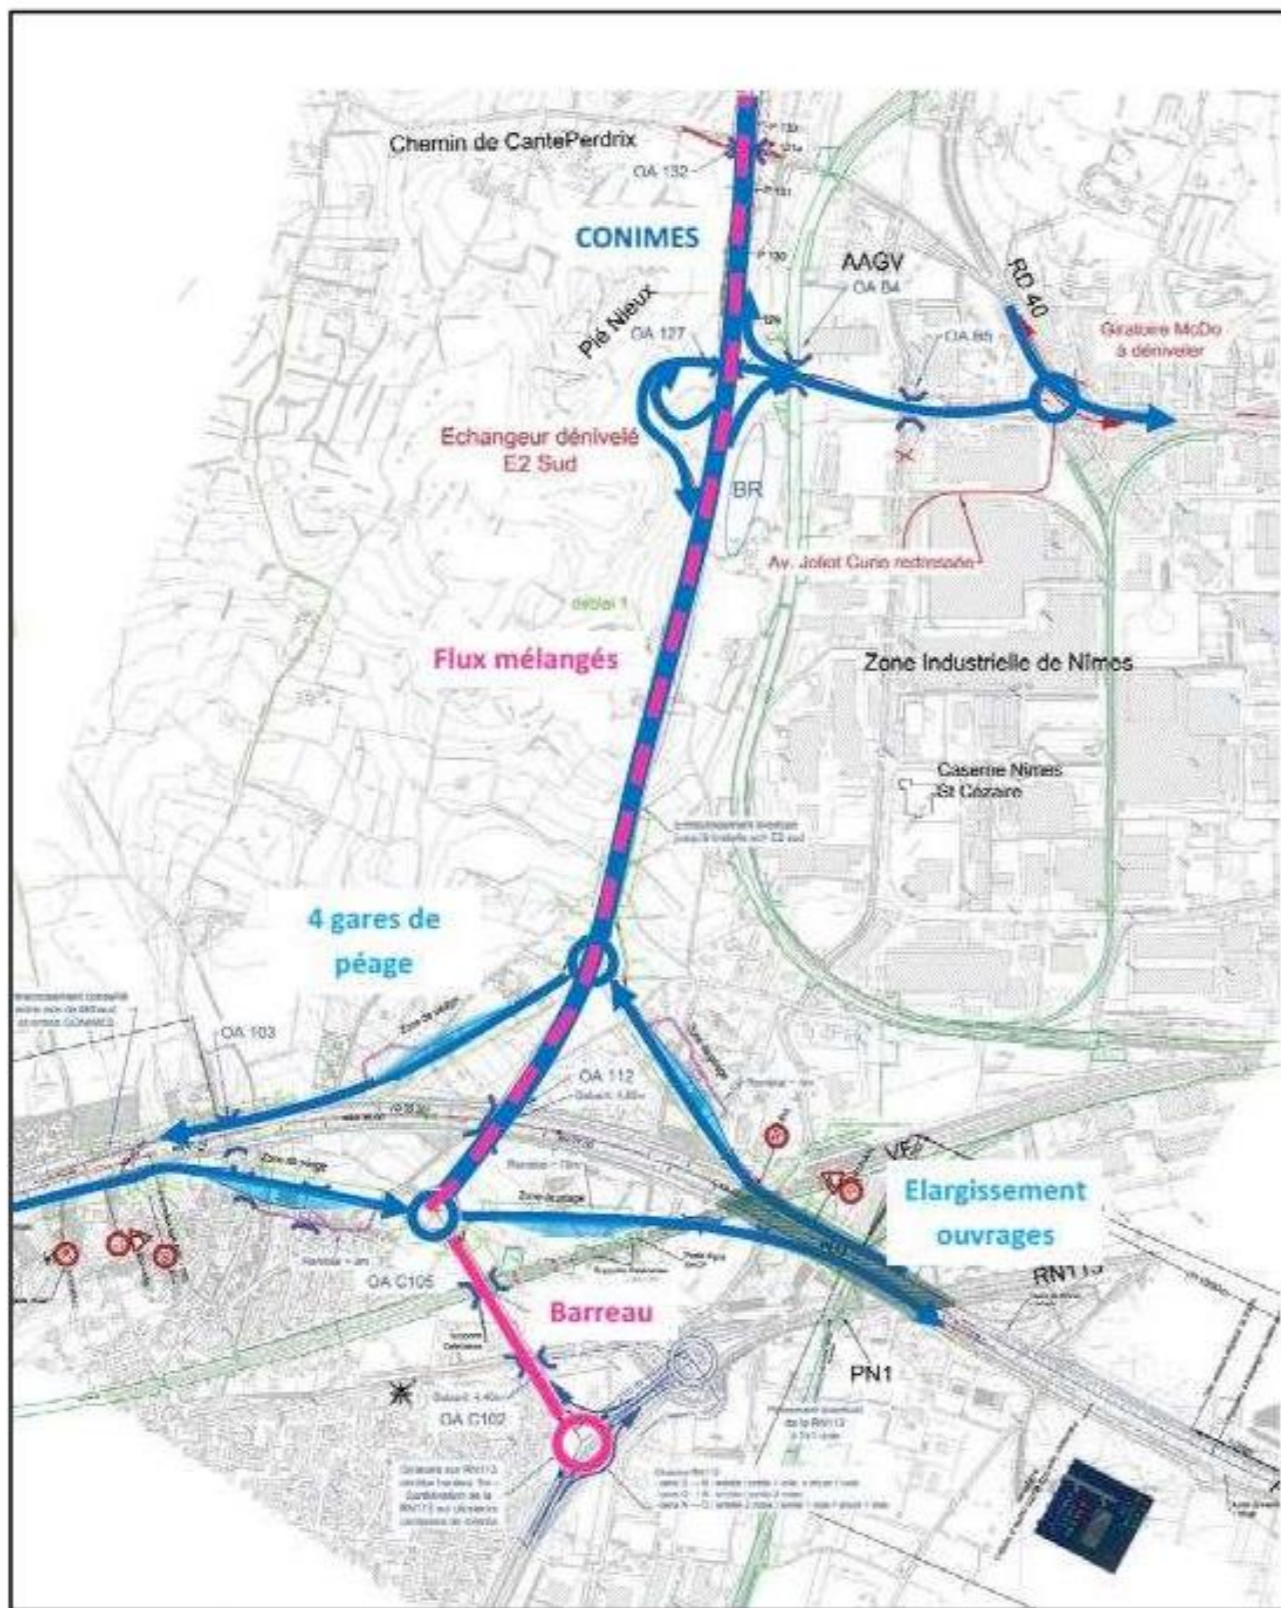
Tracé de la section Sud du CONIMES pour la deuxième variante (3C)
